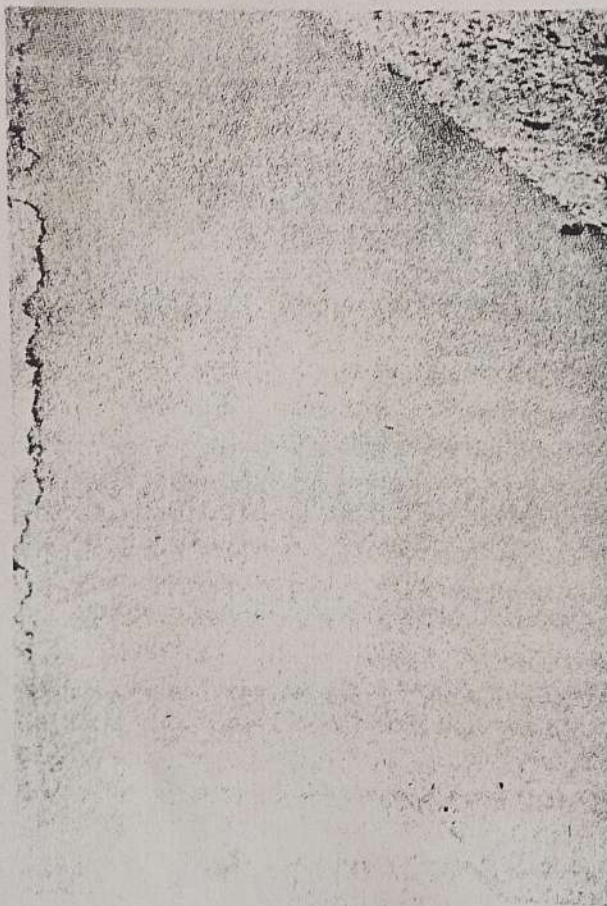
Grieta de El-sanche.
